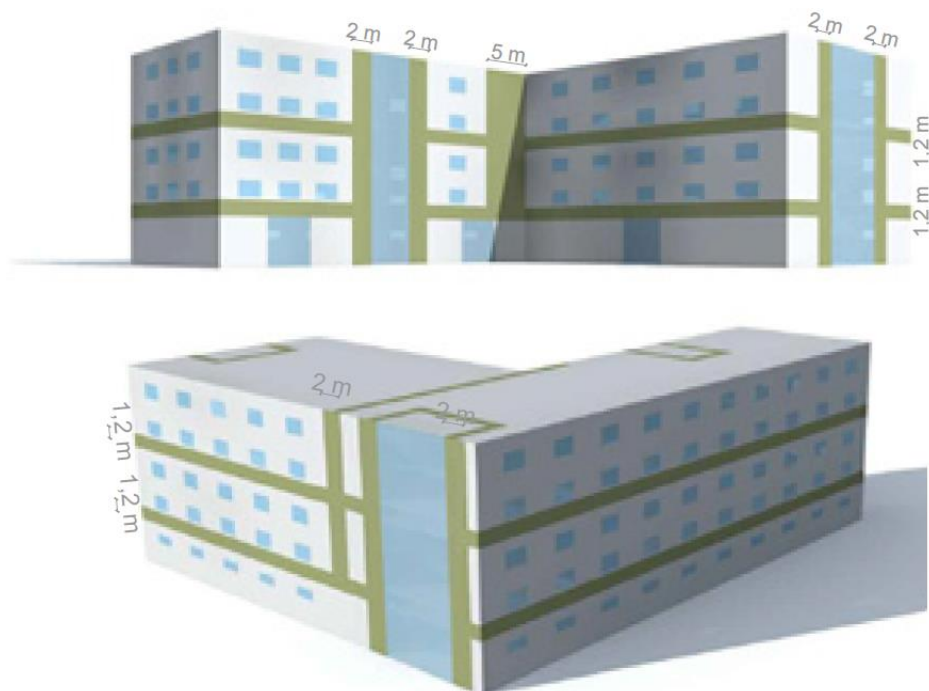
Приклад улаштування протипожежних поясів на фасаді навколо опорядження з світлопрозорих елементів
